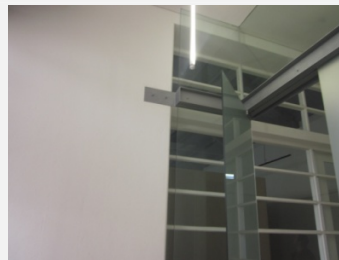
Punto de encuentro entre estructura metálica y pared. Fotografía de autor.
